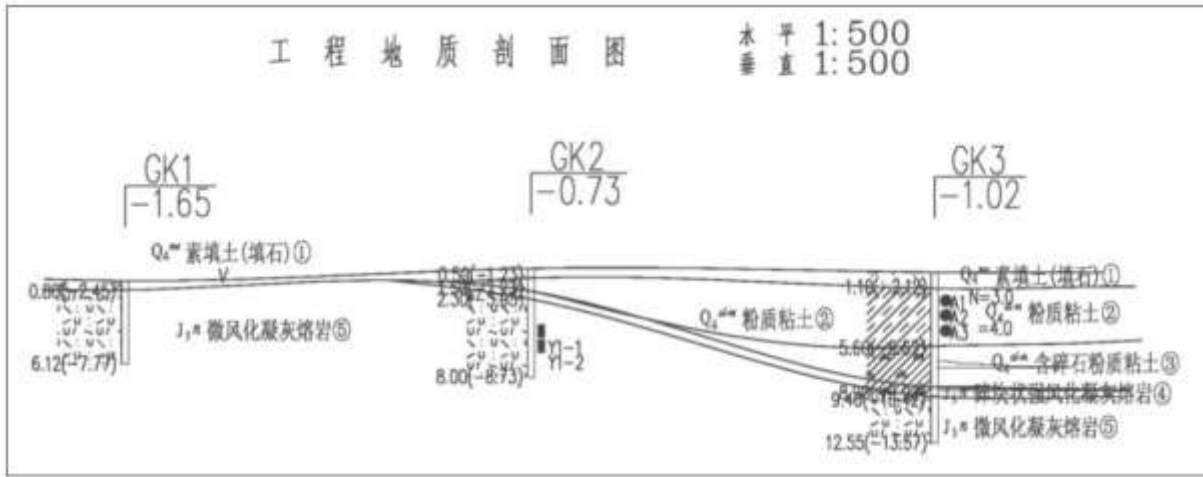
松皋陆岛交通码头工程地质剖面图 2
